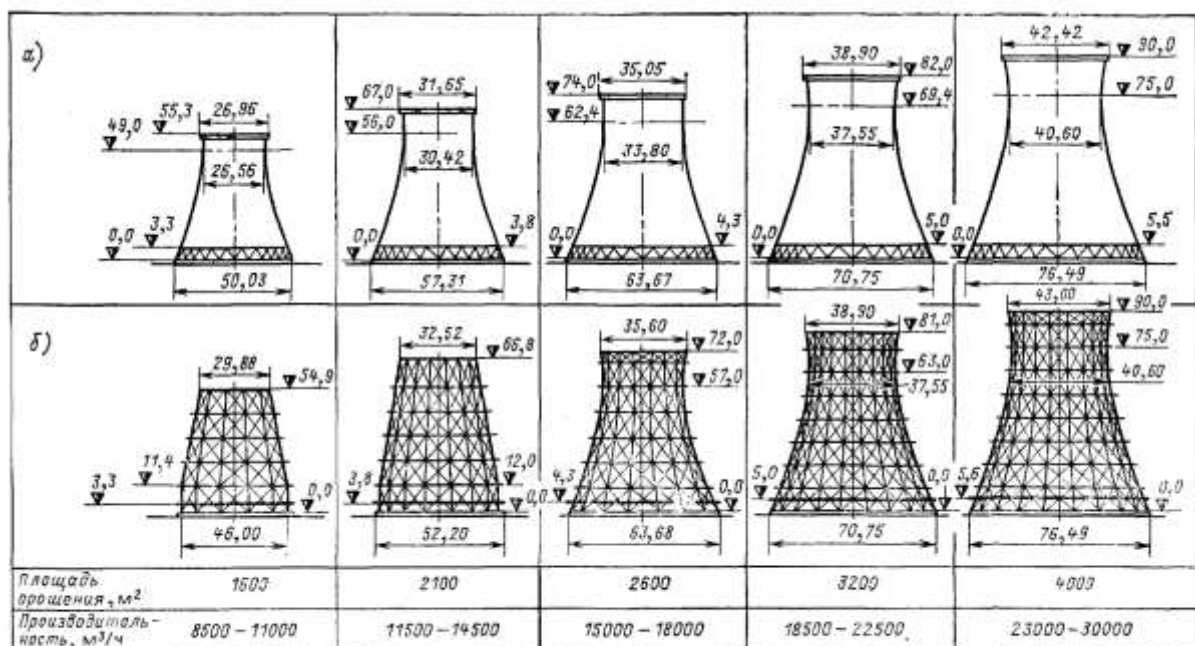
Типовые градирни площадью орошения от 1600 до 4000 м<sup>2</sup> (по АТЭП): а — с железобетонной башней; б — с каркасно-обшивной башней
